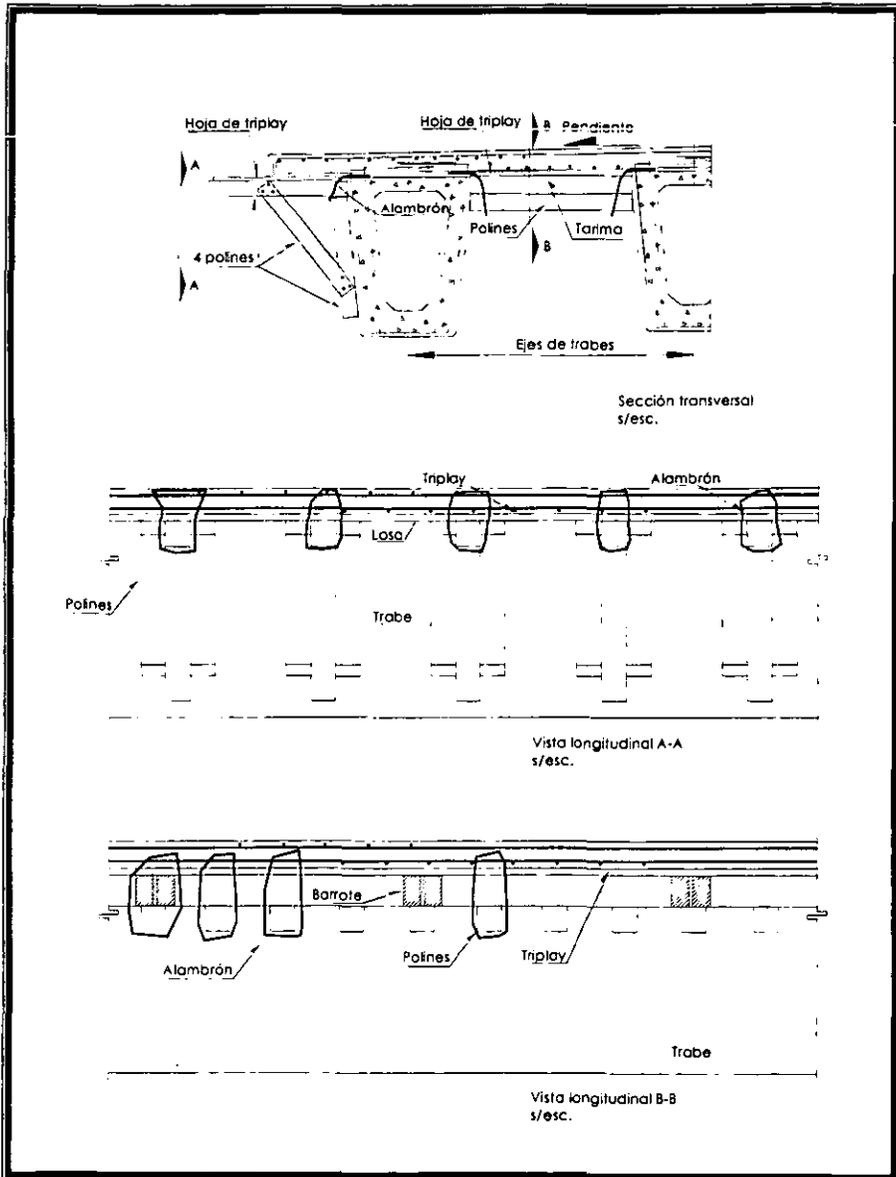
Cimbrado de losas sobre traves sin alero.
